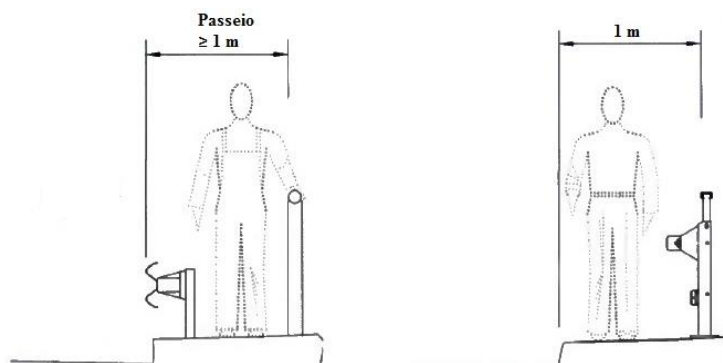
Perfis transversais tipo para passeios em obras-de-arte, adaptado SETRA [17]
